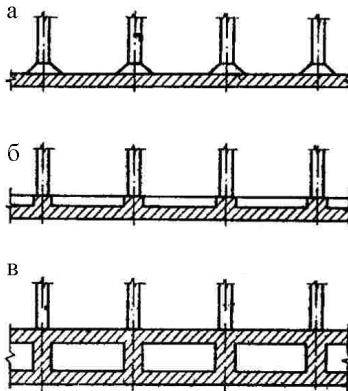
Суцільні залізобетонні фундаменти:
